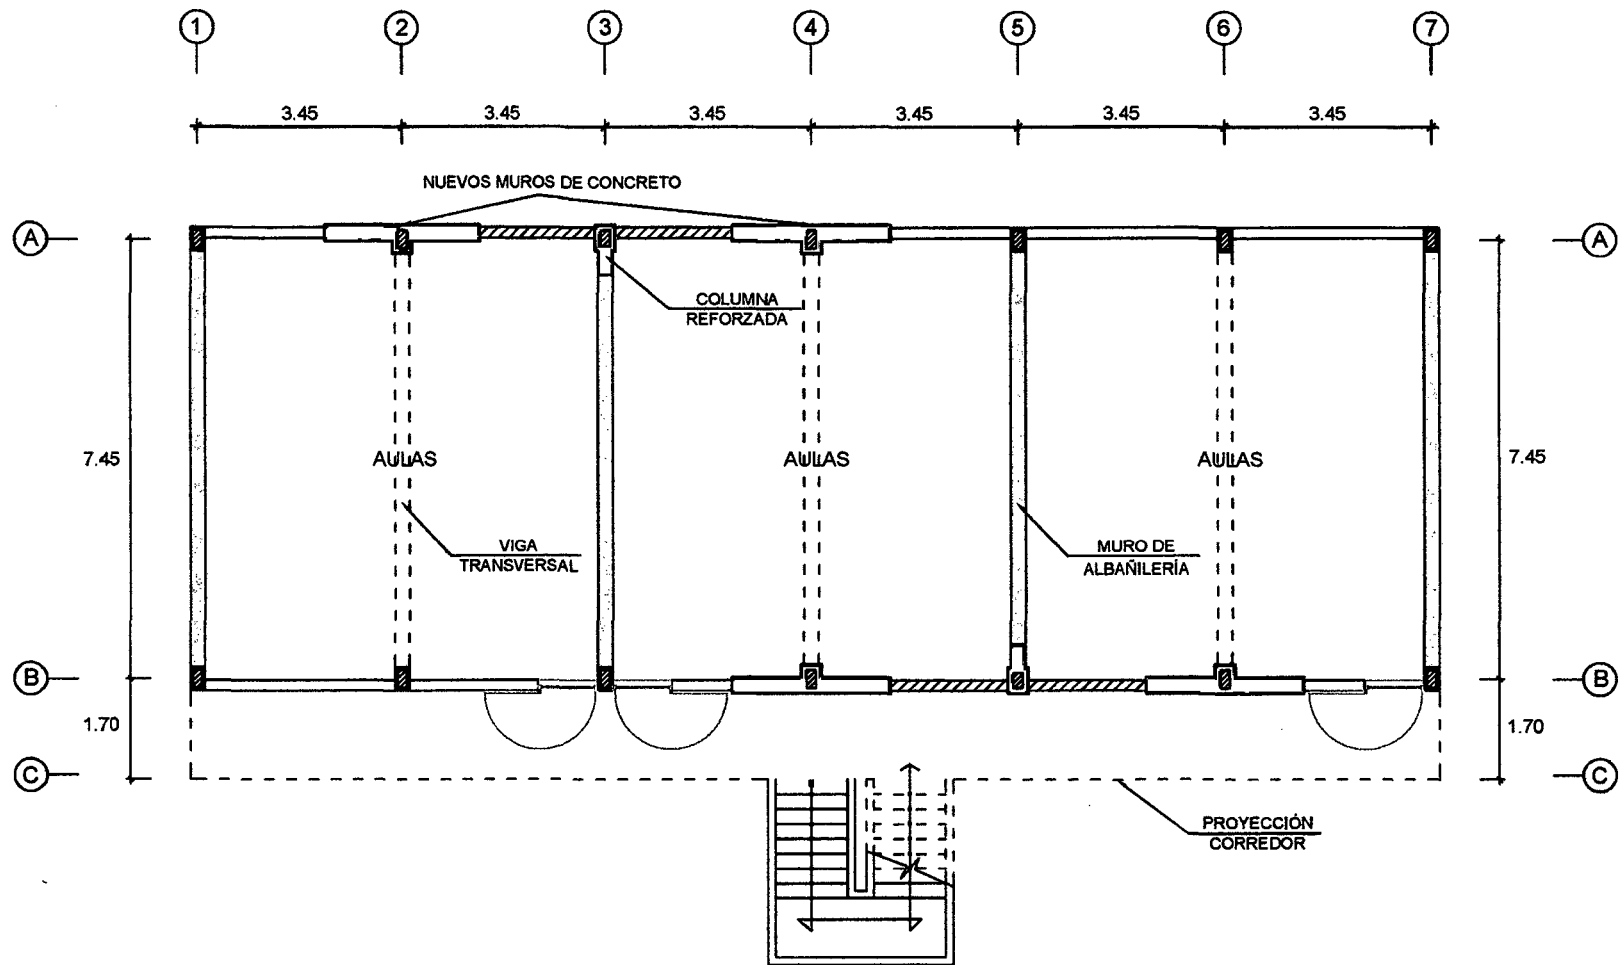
Reforzamiento del pabellón 2 con muros y vigas de concreto armado.
